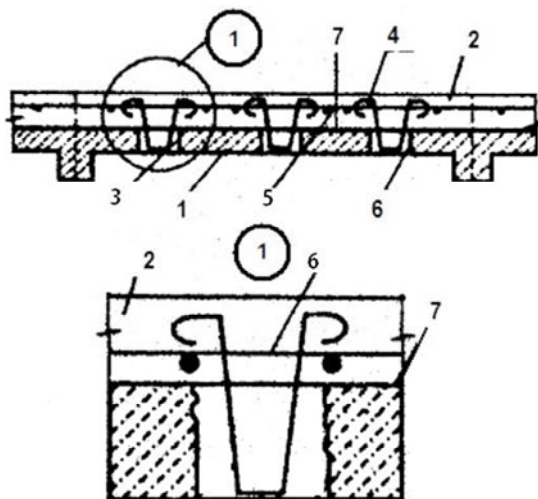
Нарращивание сверху с устройством железобетонных шпонок:
